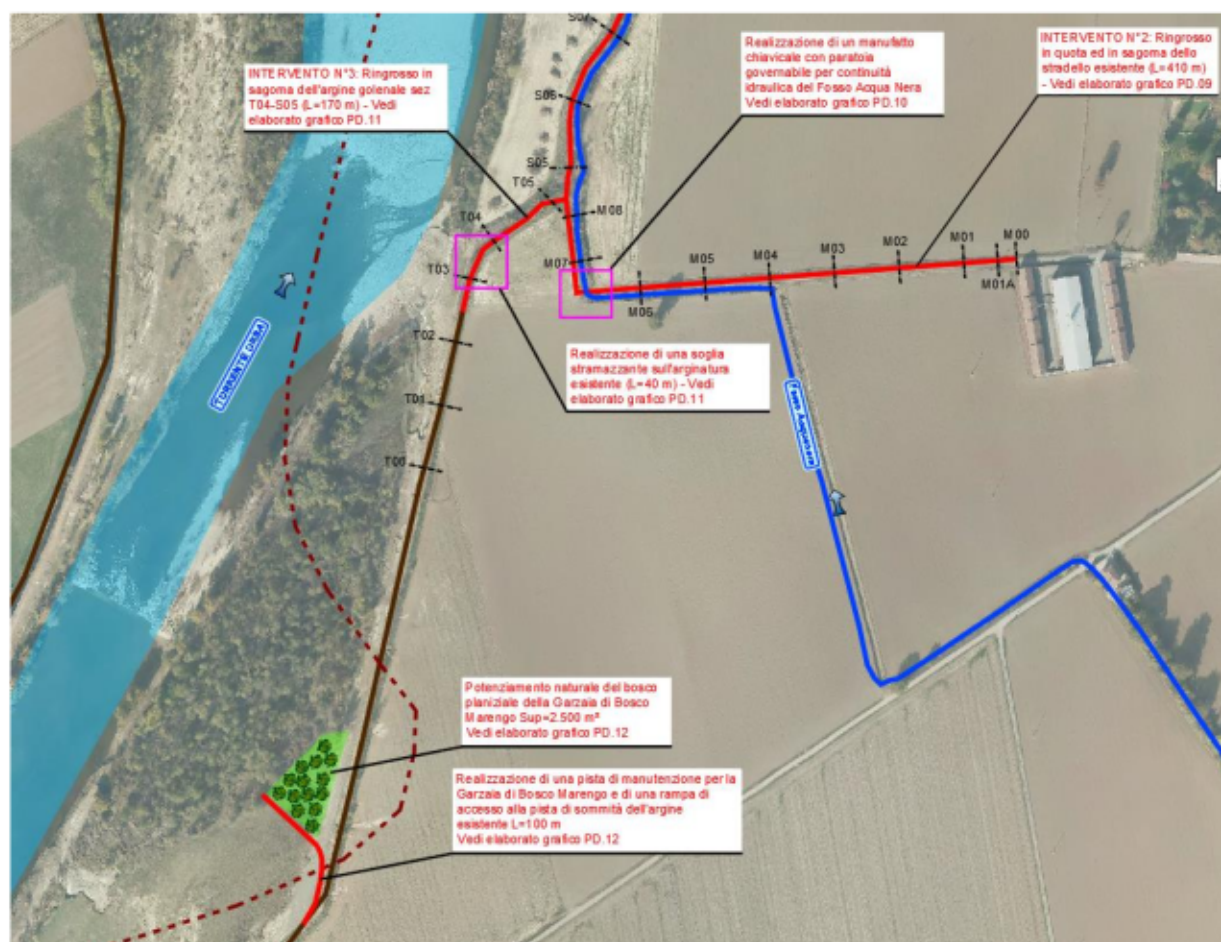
ESTRATTO DELLA PLANIMETRIA DI PROGETTO DELL'INTERVENTO N°3
